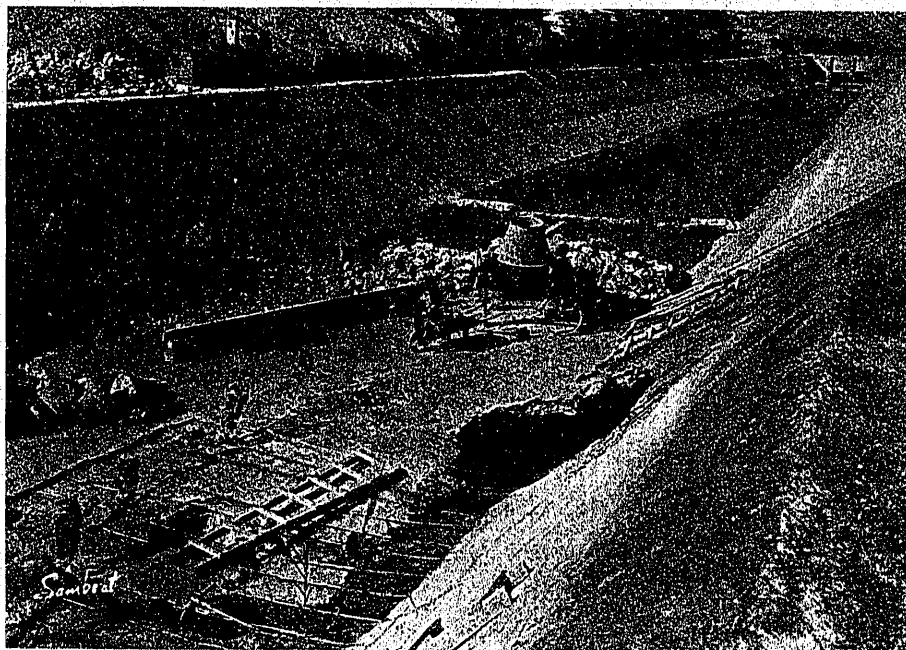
Construcción de un dique de bloques de hormigón para poder dar el agua rápidamente. Avería en el kilómetro 25,900 en 15-V-1959.
